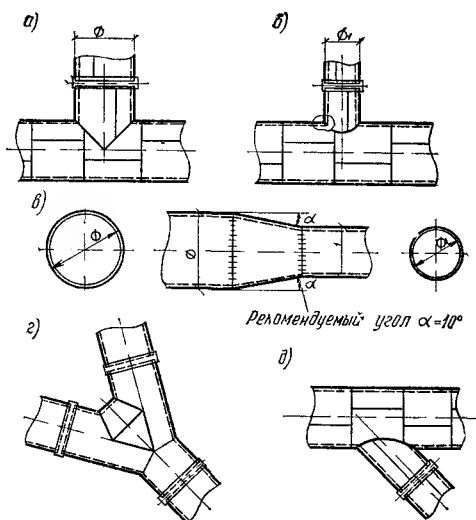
Схемы пересечения и переходов трубопроводов
